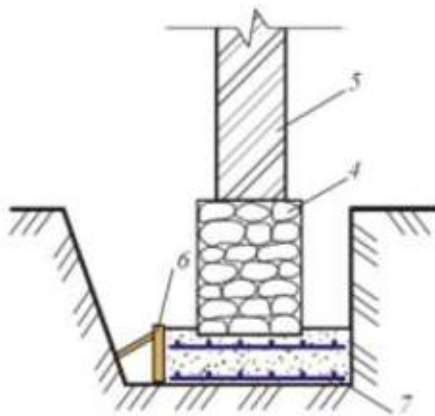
Підсилення фундаментів методом збільшення ширини підшви фундаменту.
